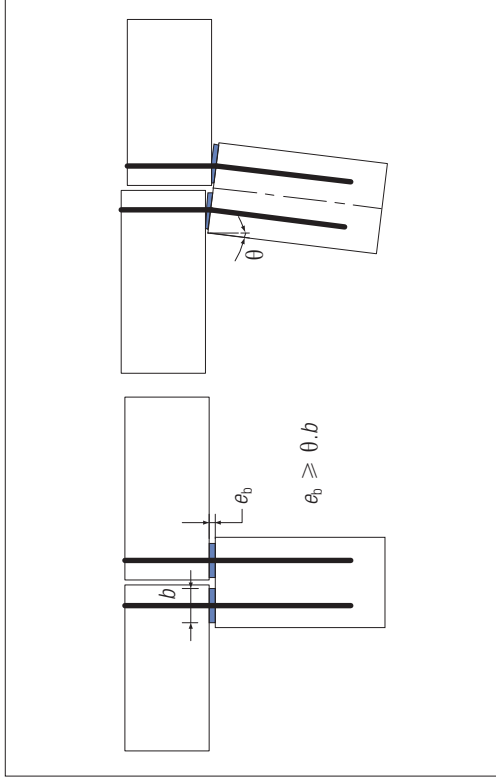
Déplacements dans un assemblage poteau-poutre articulé
